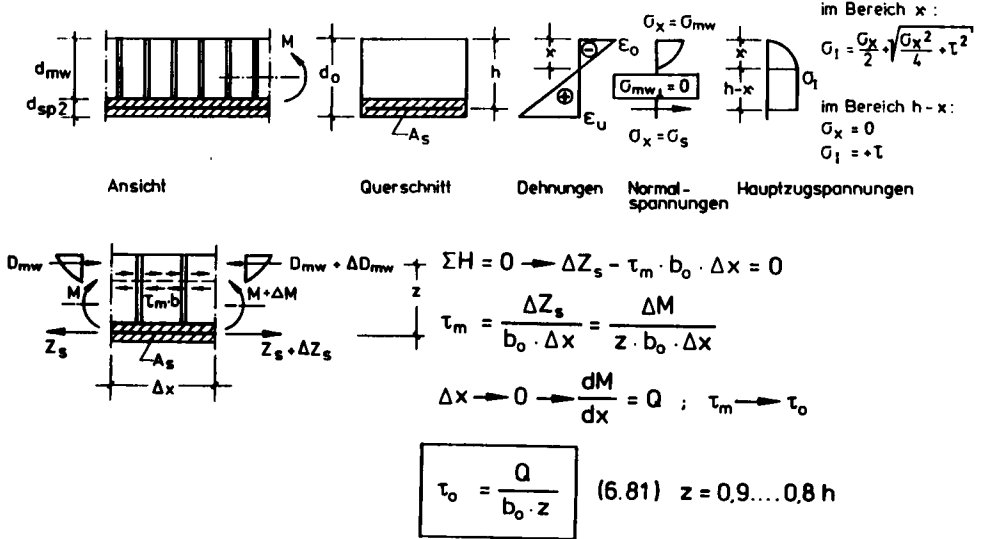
Schubtragmodell flächenhaft verstärkten Mauerwerks mit betonstahlbewehrten Ergänzungsschichten
